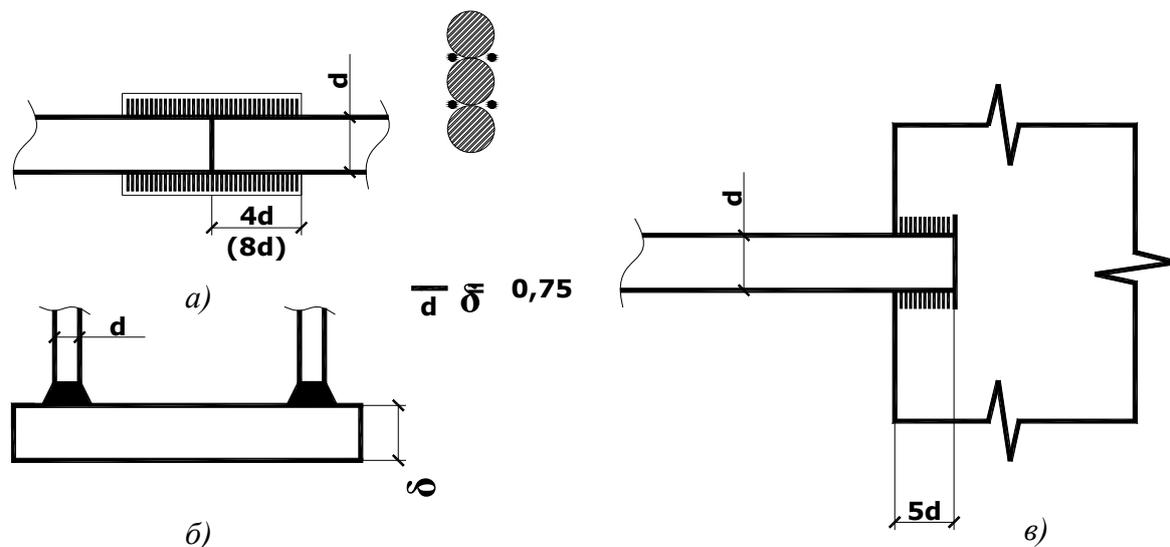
Соединение стержней с пластинами: а – с накладками; б – втавр; в – внахлестку фланговыми швами
